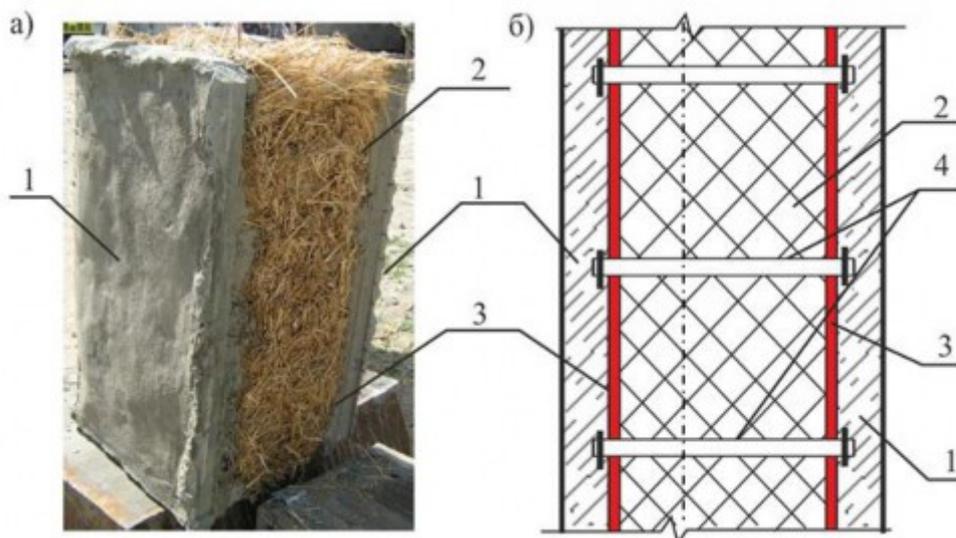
Новая многослойная конструкция «Наружная стена»: а– общий вид; б – поперечный разрез: 1– армированный торкрет-бетон, 2 – органический утеплитель; 3 – контактный слой, 4 – связи
